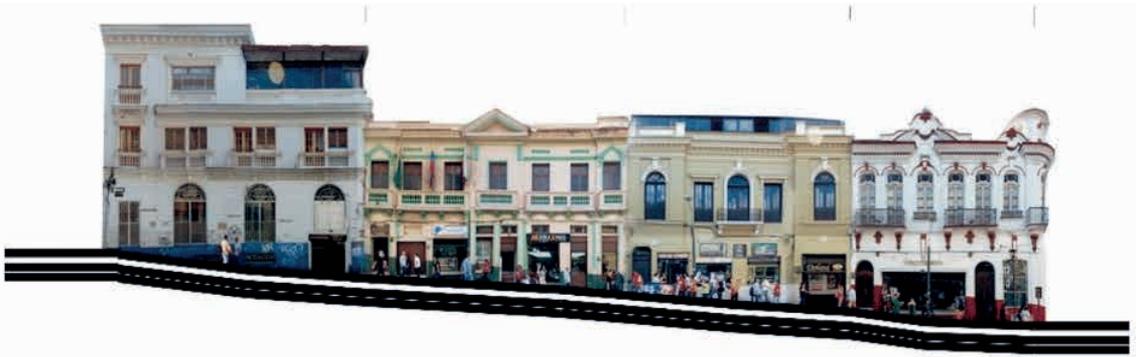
Tramo de fachadas en la carrera 22 entre calles 23 y 24
